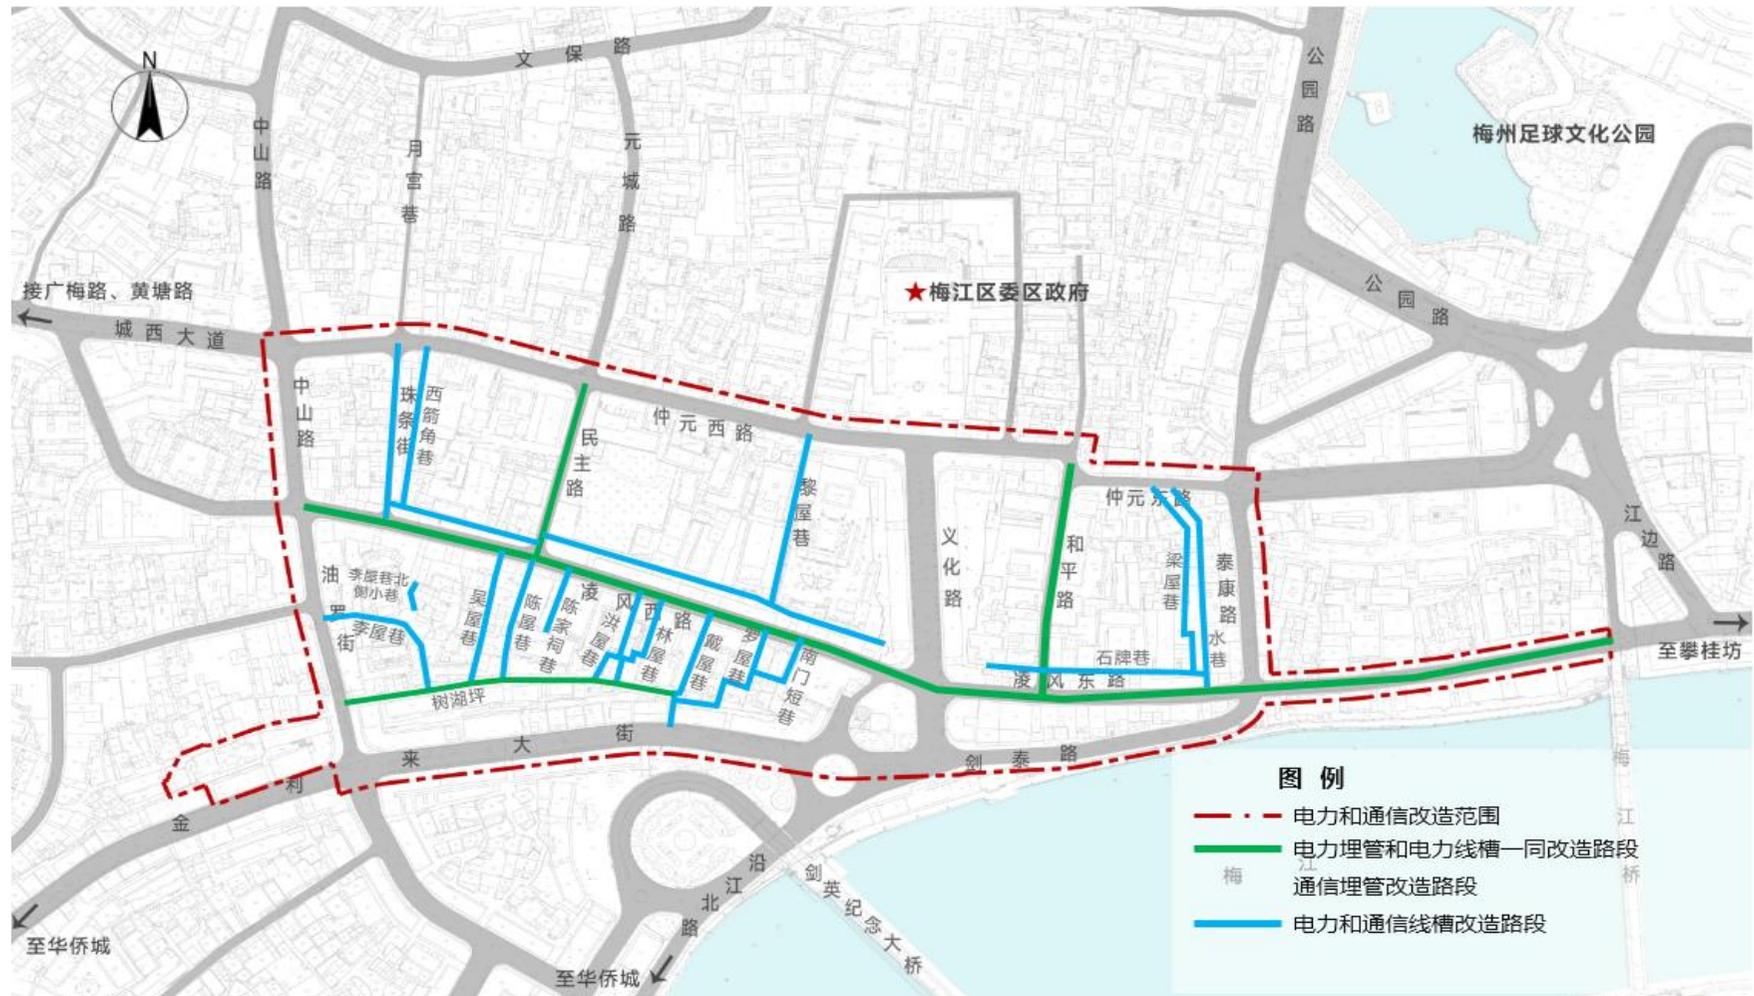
综合管线（电力通信）工程改造总平面图
